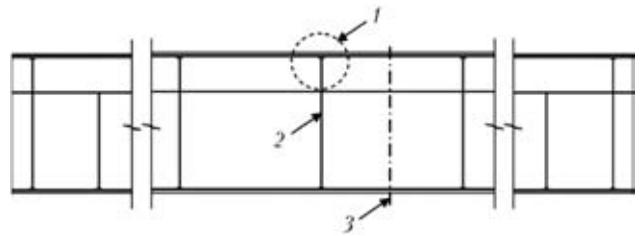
Расположение исследуемого сварного узла: 1 — исследуемый сварной узел; 2 — поперечное ребро; 3 — середина пролета
